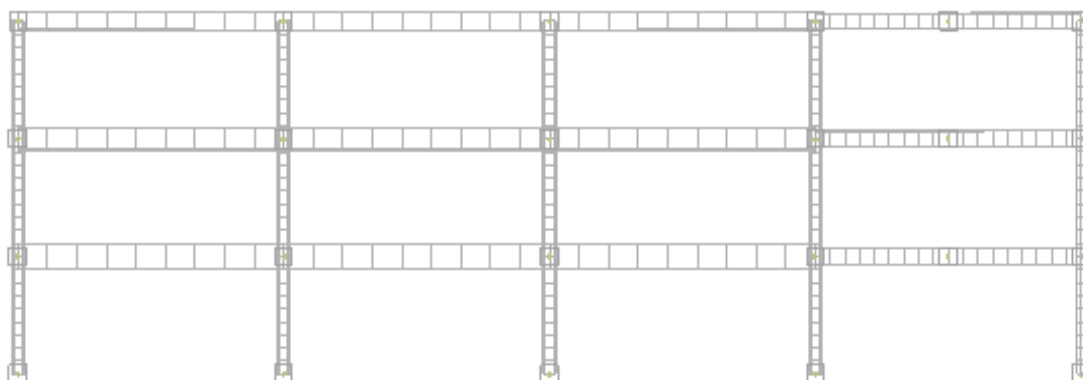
Configuração indeformada - Estrutura benchmark .
